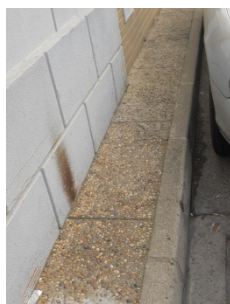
lajetas pré-fabricadas em betão com acabamento em godo lavado - beje
